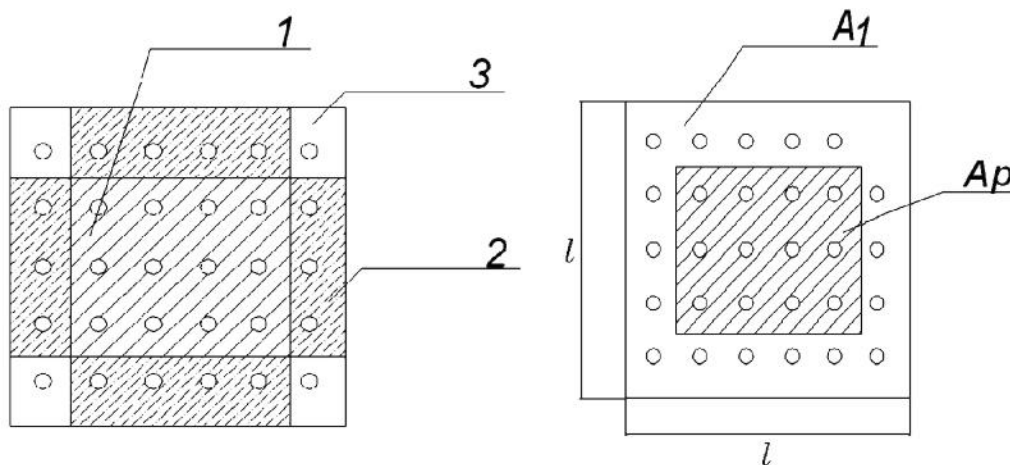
Условная схема разбиения свайного поля и плиты ростверка
